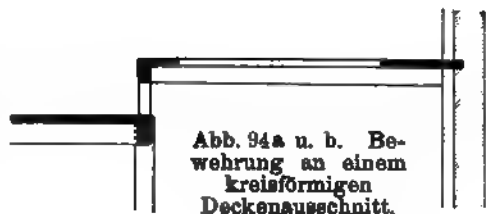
u. b. Bewehrung an einem kreisförmigen Deckenausschnitt.
